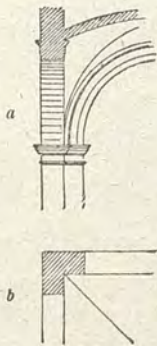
Volta a crociera su archi di testa con spalle, ossia su pilastri con alette.
